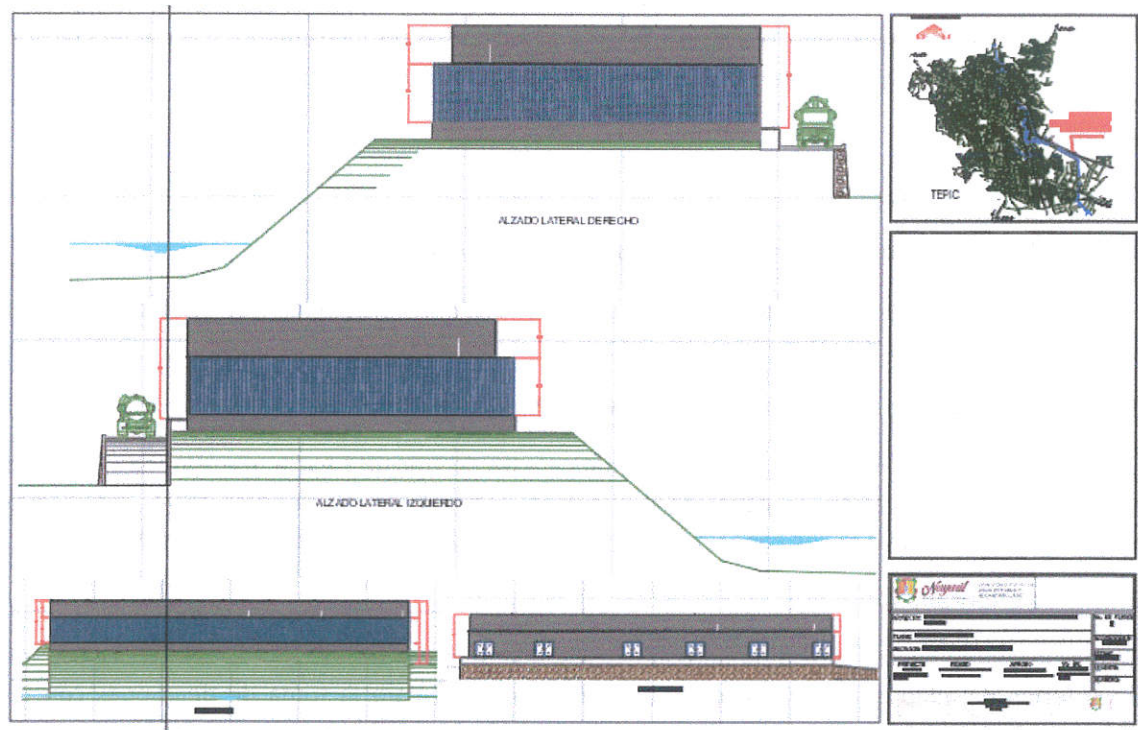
Planta PTAR Oriente. (Fuente: propia)
